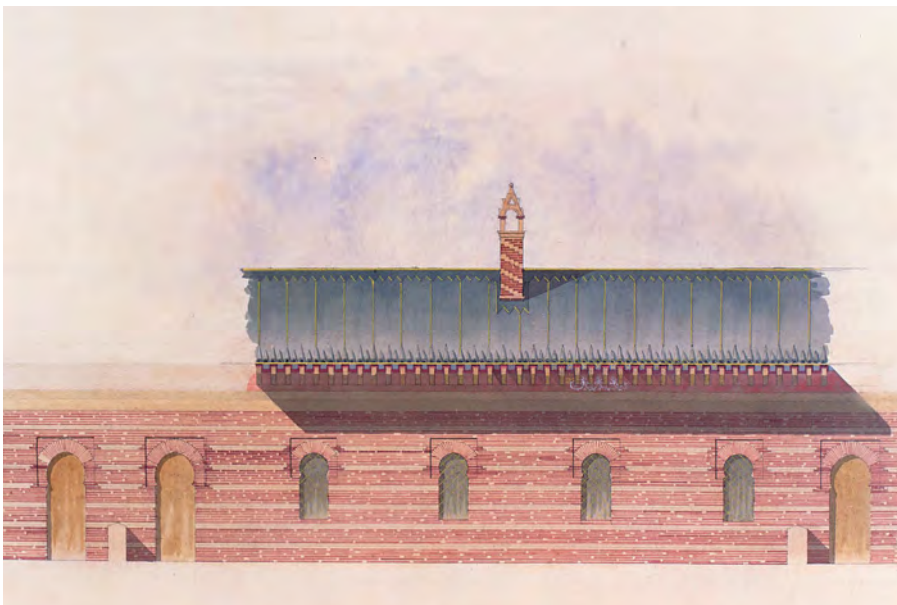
Alzado interior hacia el patio de la última planta del palacio.
